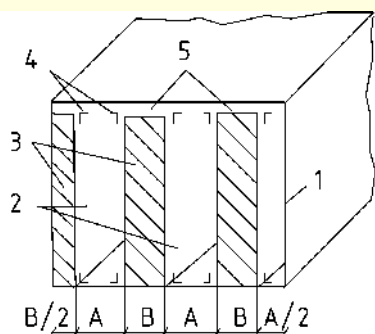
Вариант компоновки пластинчатого глушителя: 1 – кожух; 2 – каналы для воздуха; 3 – звукопоглощающие пластины; 4 – направляющие уголки; 5 – монтажный зазор толщиной 8–10 мм, уплотняемый после установки пластин
